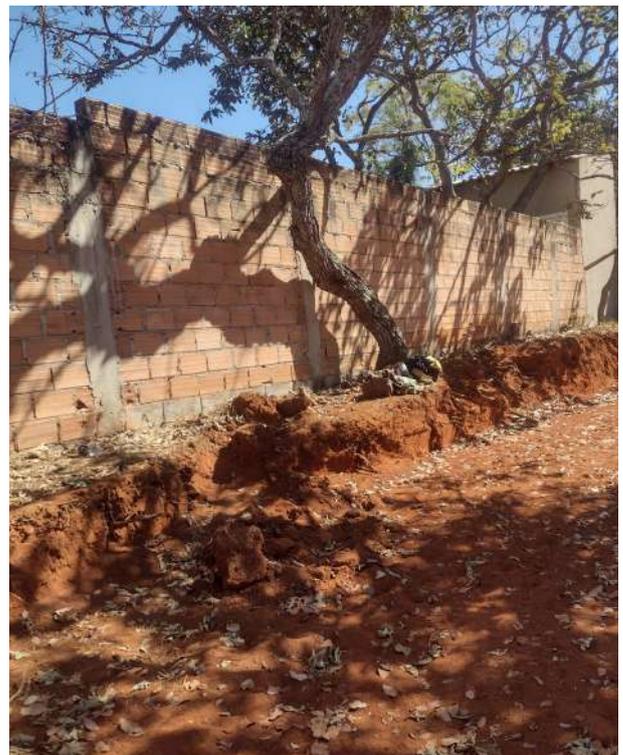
Pequizeiro e peroba do campo na área da construção.
